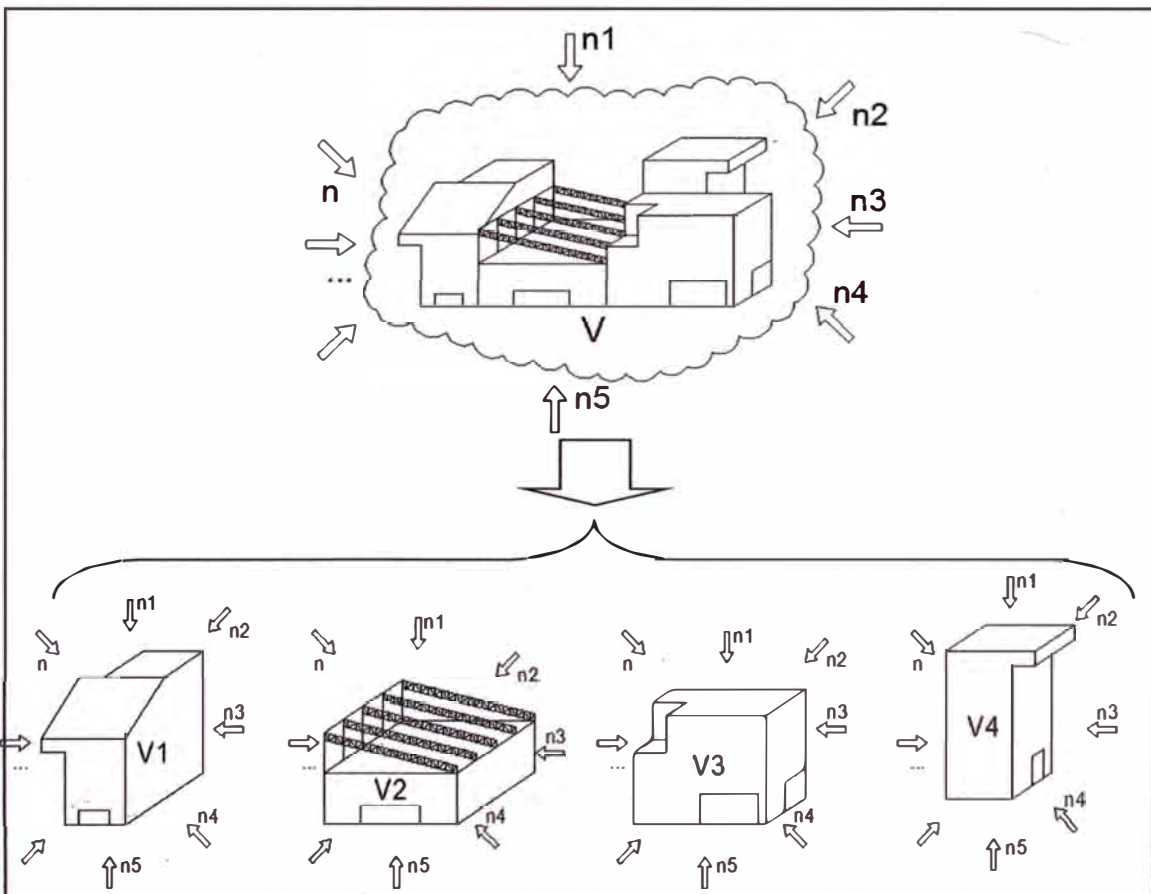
División de un objeto de construcción, particionado por las juntas de dilatación.
